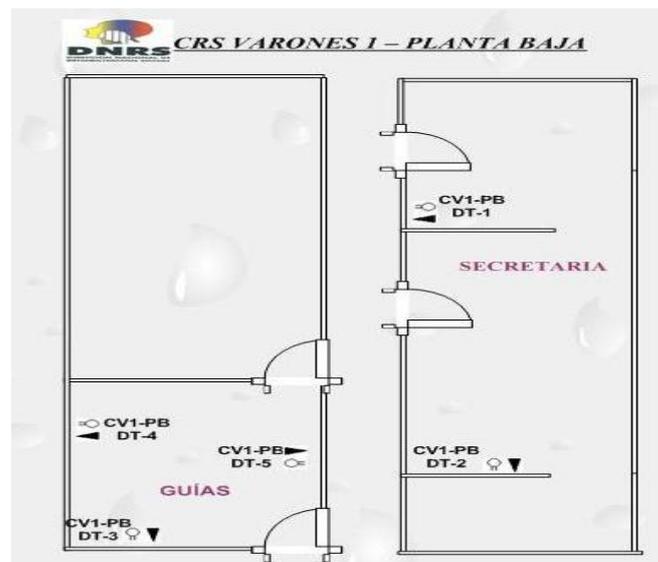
Plano Planta Baja CRS Varones 1
